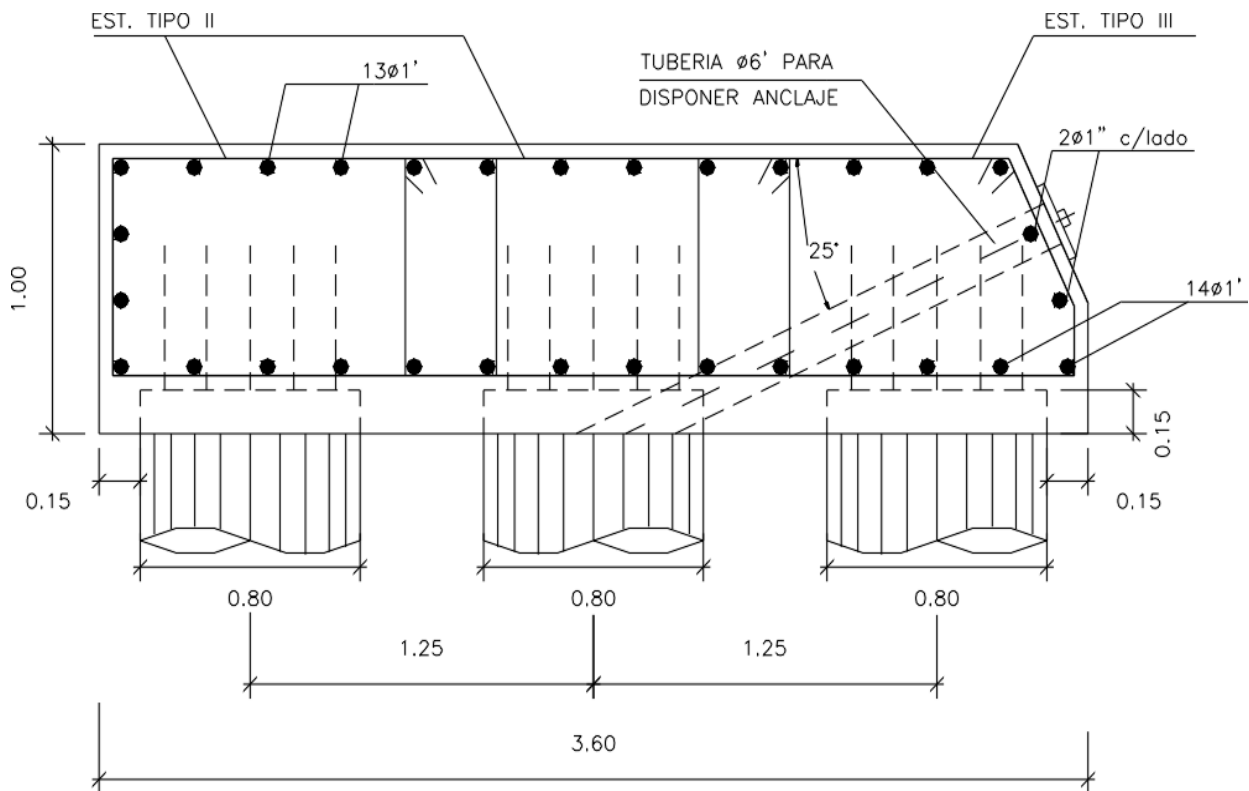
Detalle de losa en sitio con tres filas de pilotes.
